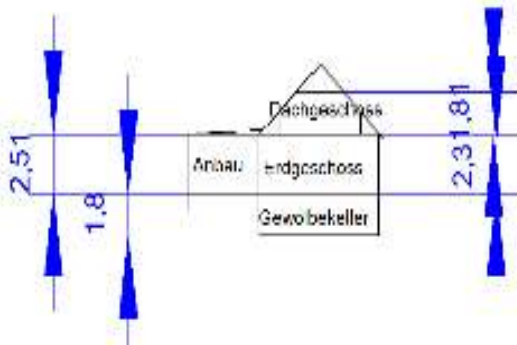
Schnittsskizze Wohnhaus mit Anbau
